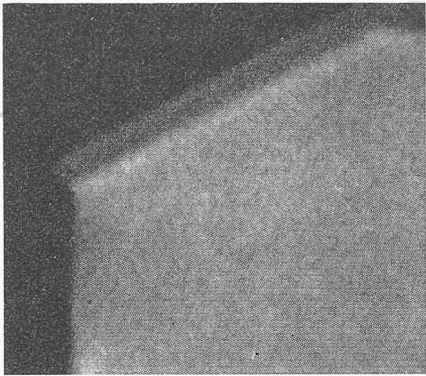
(links). Isolationstechnisch einwandfreie Fassade. – Bild 10 (Mitte). Massive Wärmeverluste durch mangelhafte Isolation von Betondecken. – Bild 11 (rechts). Sichtbarmachung von Riegelfachwerk, welches dem blossen Auge durch eine Putzschicht verdeckt bleibt
